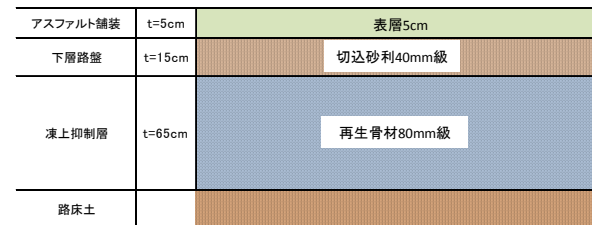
試験施工箇所 (芦別市) 施工時期 H24. 9
